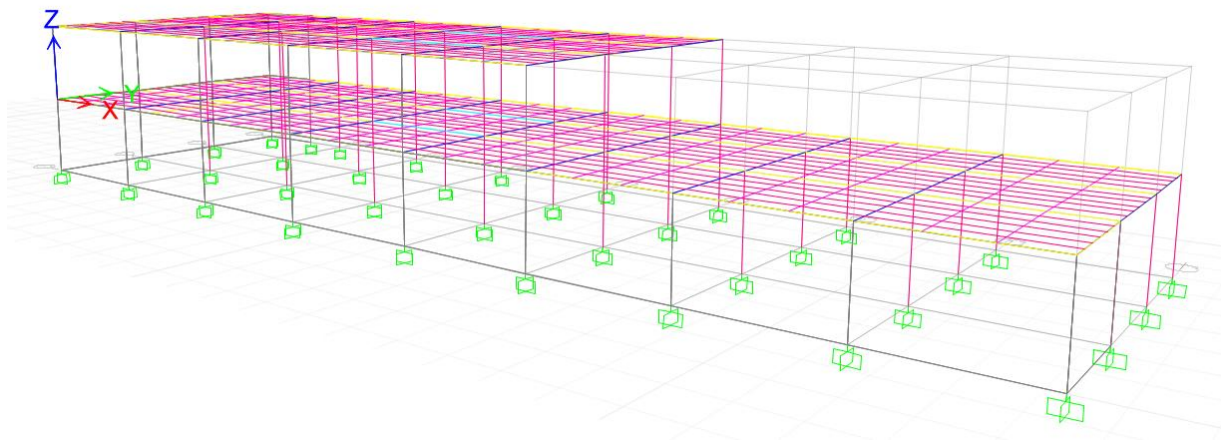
Modelo Estructural Bloque de Parqueos, FUENTE: ETABS
